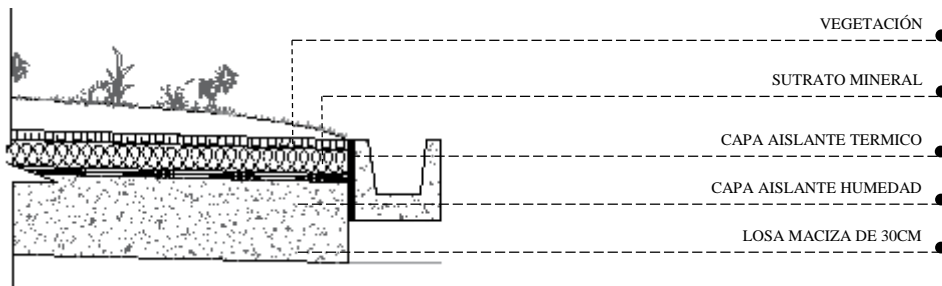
Sección constructiva - techo verde o cobertura ajardinada. Fuente: propia.
